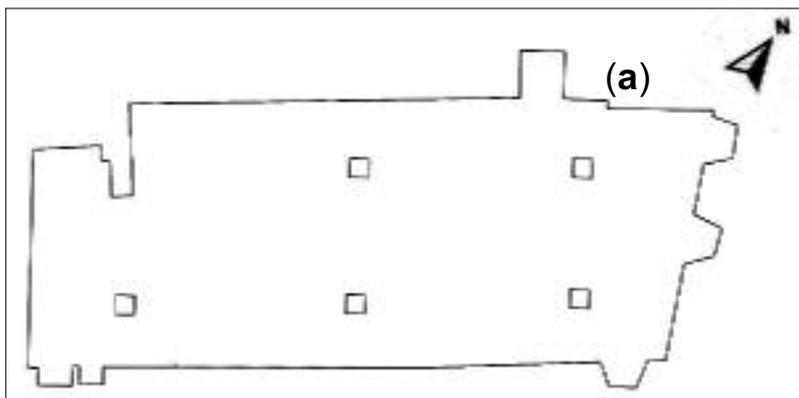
Planimetria ricavata dal modello tridimensionale, con indicazione (a) dello spigolo forse connesso al preesistente perimetro dell'ambiente.
